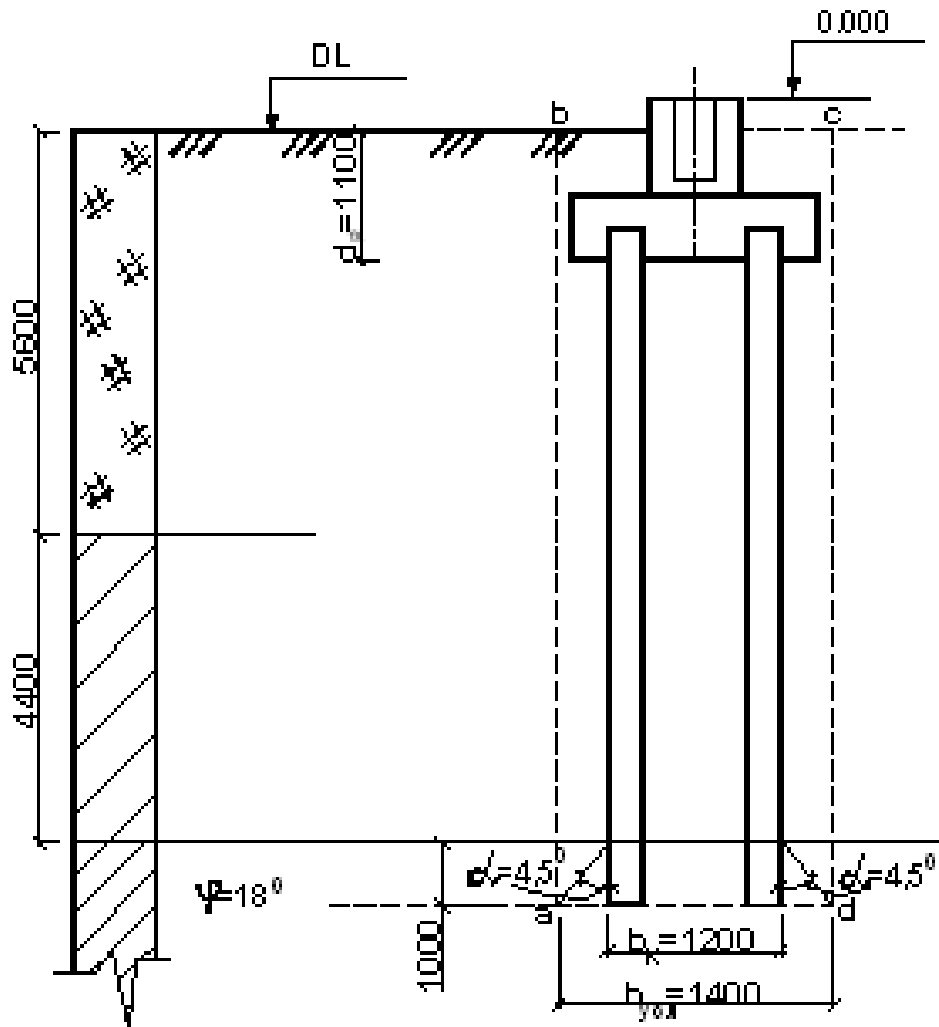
К расчету условного свайного фундамента (пример при первых двух слабых слоях)
